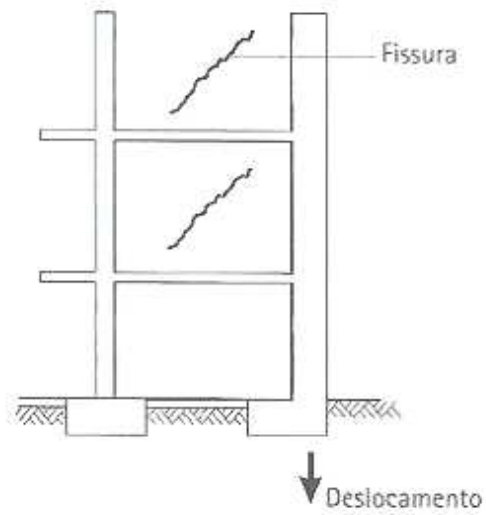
Fissuras por recalque de fundação de pilar de canto - CONSOLI; MILITITSKY; SCHINAID, 2008.
